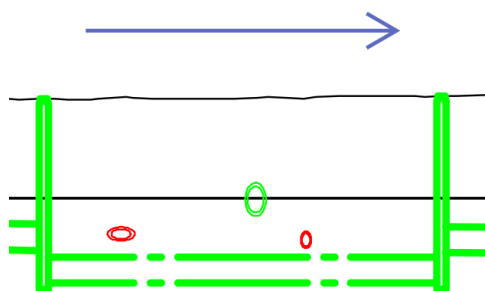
Sektion B över korsning mellan lila alternativ och befintlig vägtrumma.
